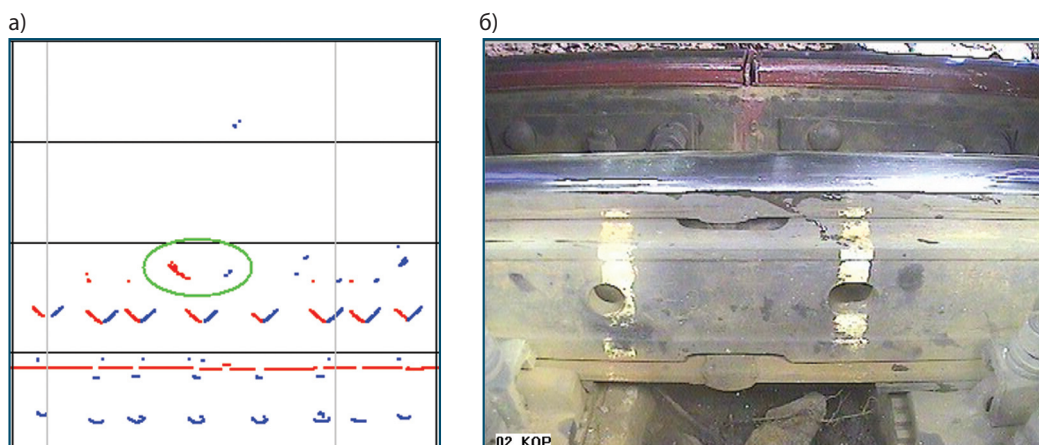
Алюминотермитный сварной стык: а – сигналы от опасной трещины в подошве рельсов в зоне сварки; б – видеокадр, идентифицирующий наличие сварного стыка.
